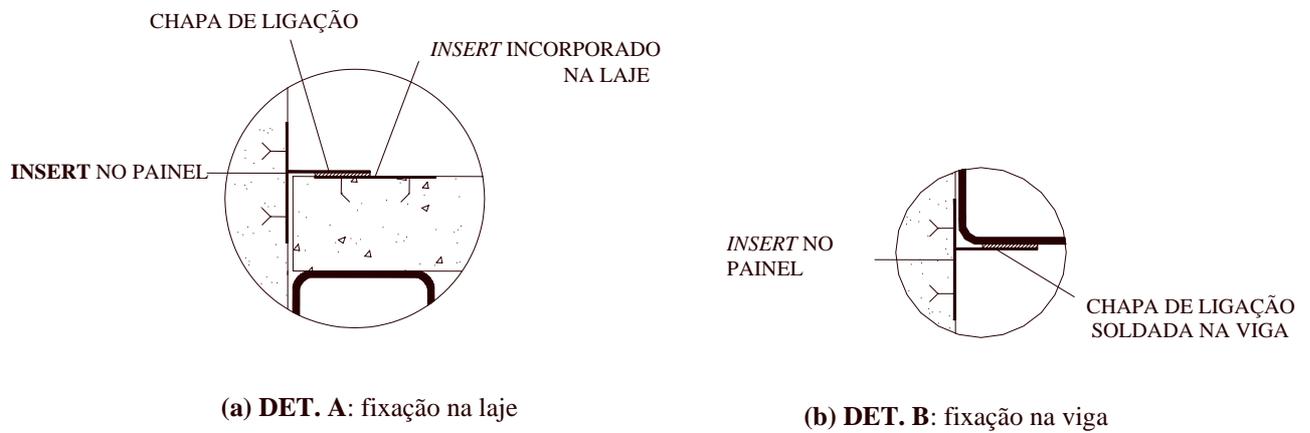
Detalhes de fixação do painel cortina: (a) Fixação na laje – (b) Fixação na viga.
